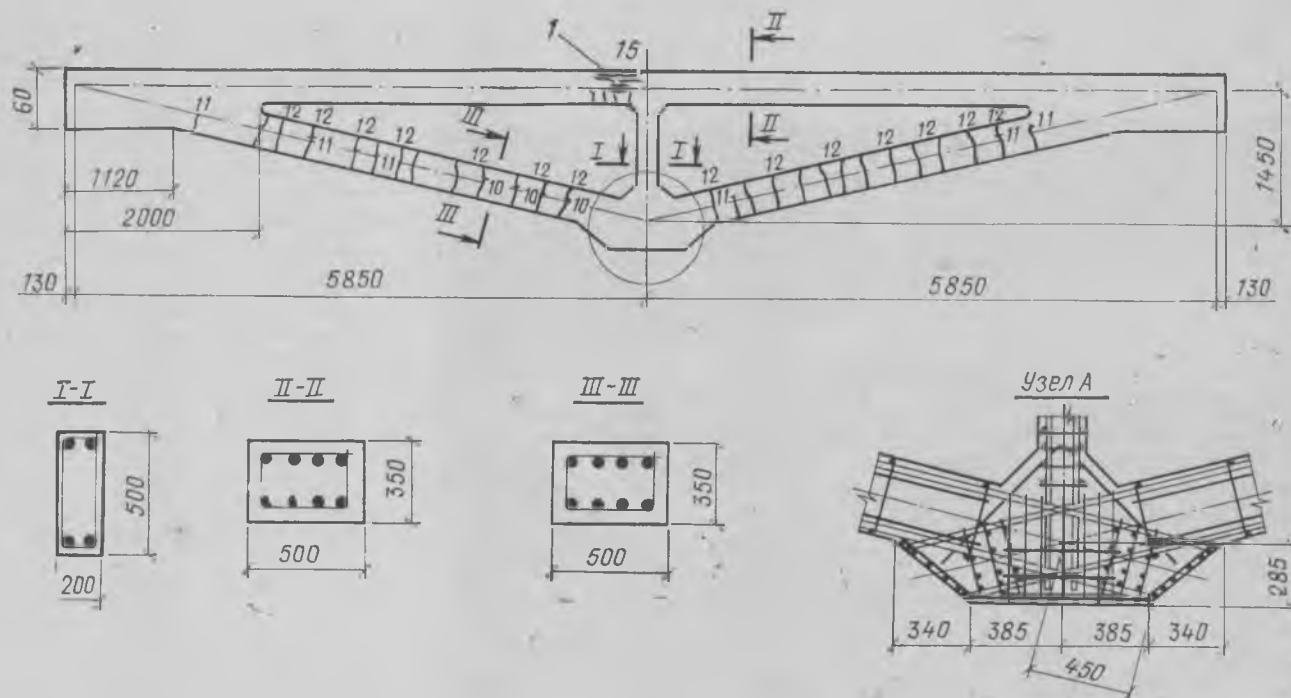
Конструкция подстропильной фермы пролетом 12 м с раздельным армированием панелей нижнего пояса и схема расположения трещин
